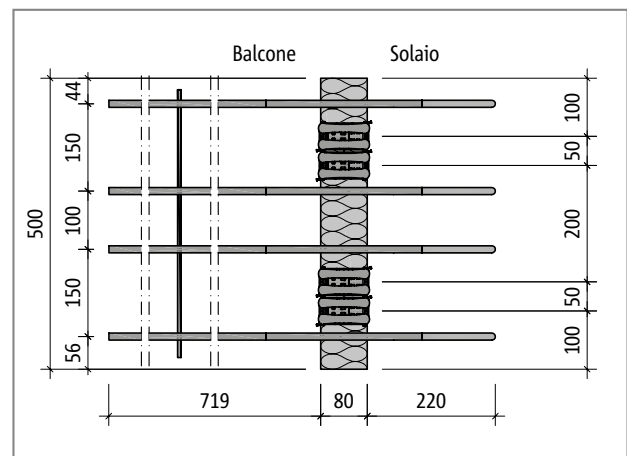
Schöck Isokorb® tipo QP60M: pianta del prodotto
